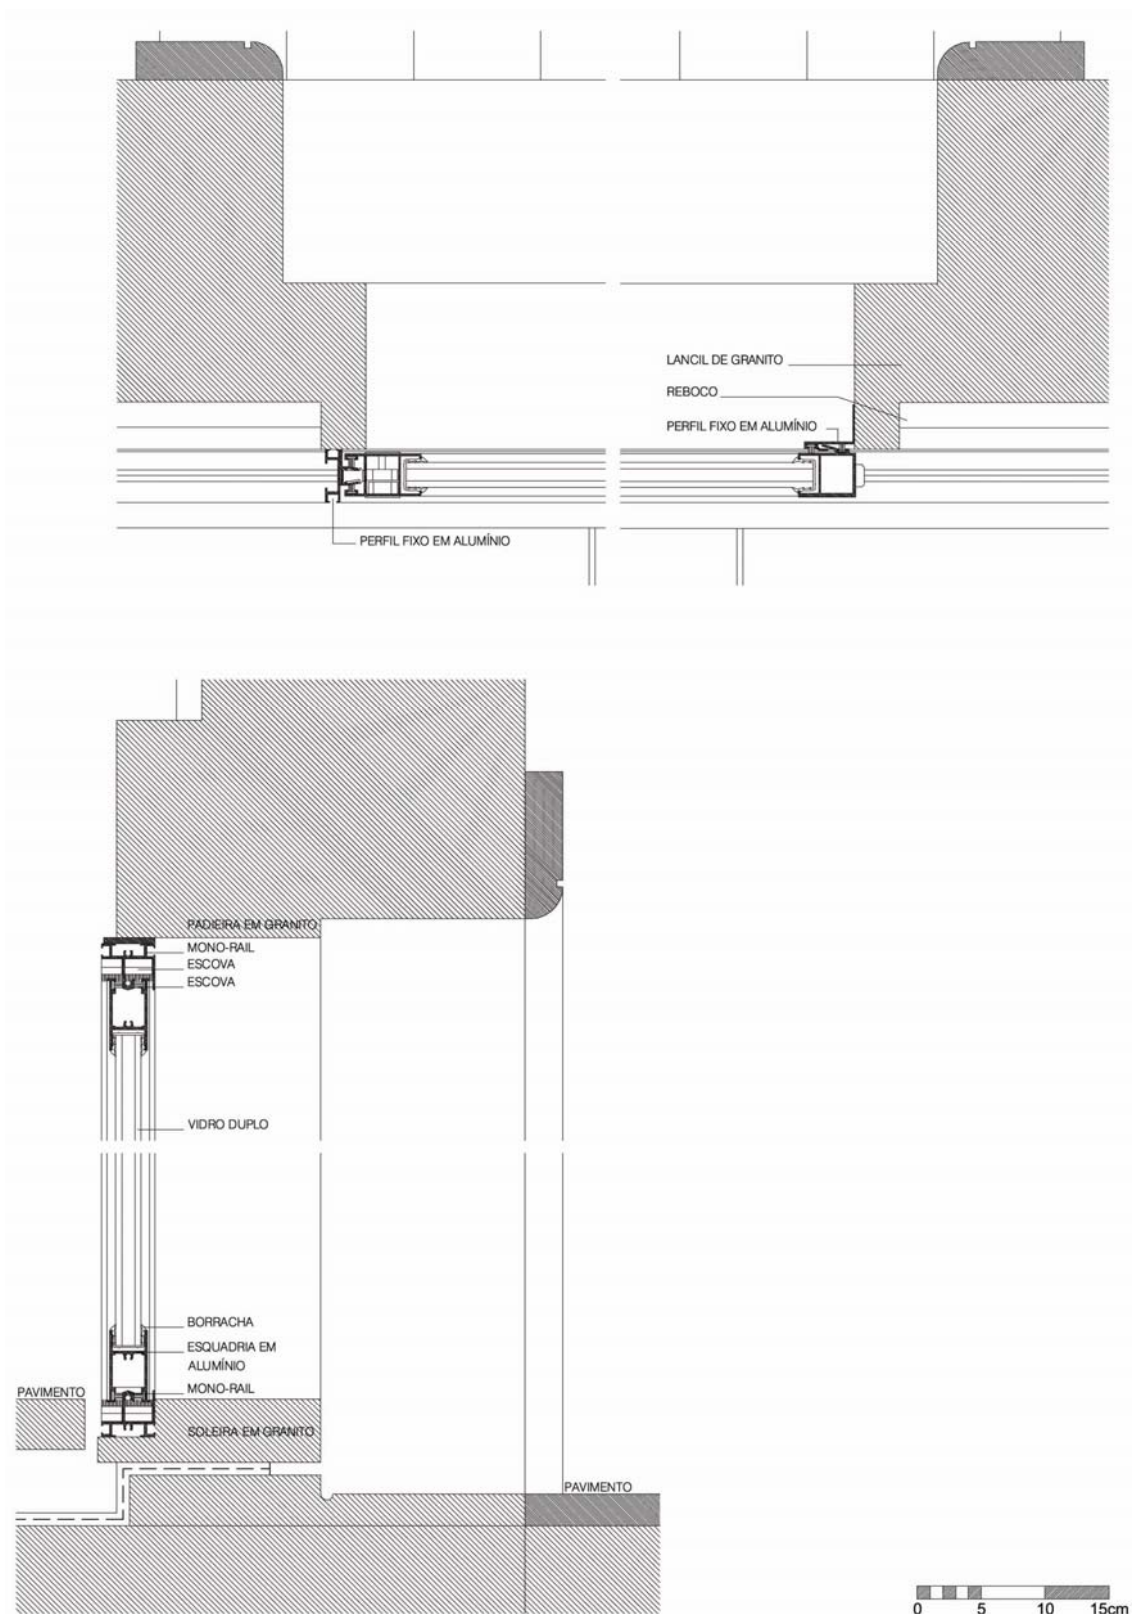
Substituição da caixilharia existente através da selecção exigencial de uma nova caixilharia - caso de estudo em alumínio. Pormenor do corte horizontal e pormenor do corte vertical.
